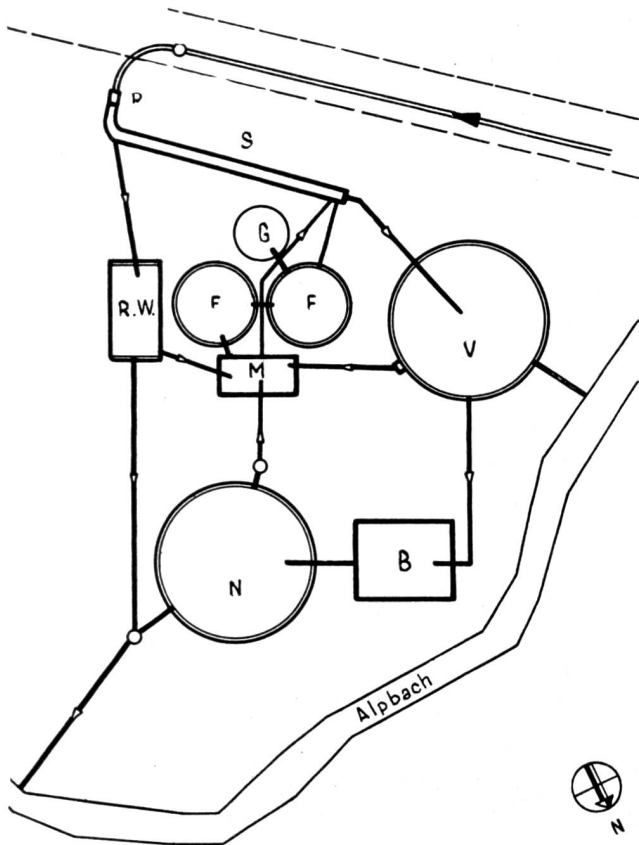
Variante VIII: Ein flaches, rundes Vorklärbecken, Belebtschlammbecken mit flachem, rundem Nachklärbecken.
